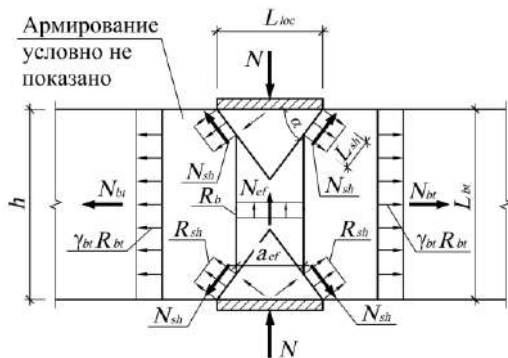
Расчетная схема надколонной плиты при действии монтажных нагрузок
